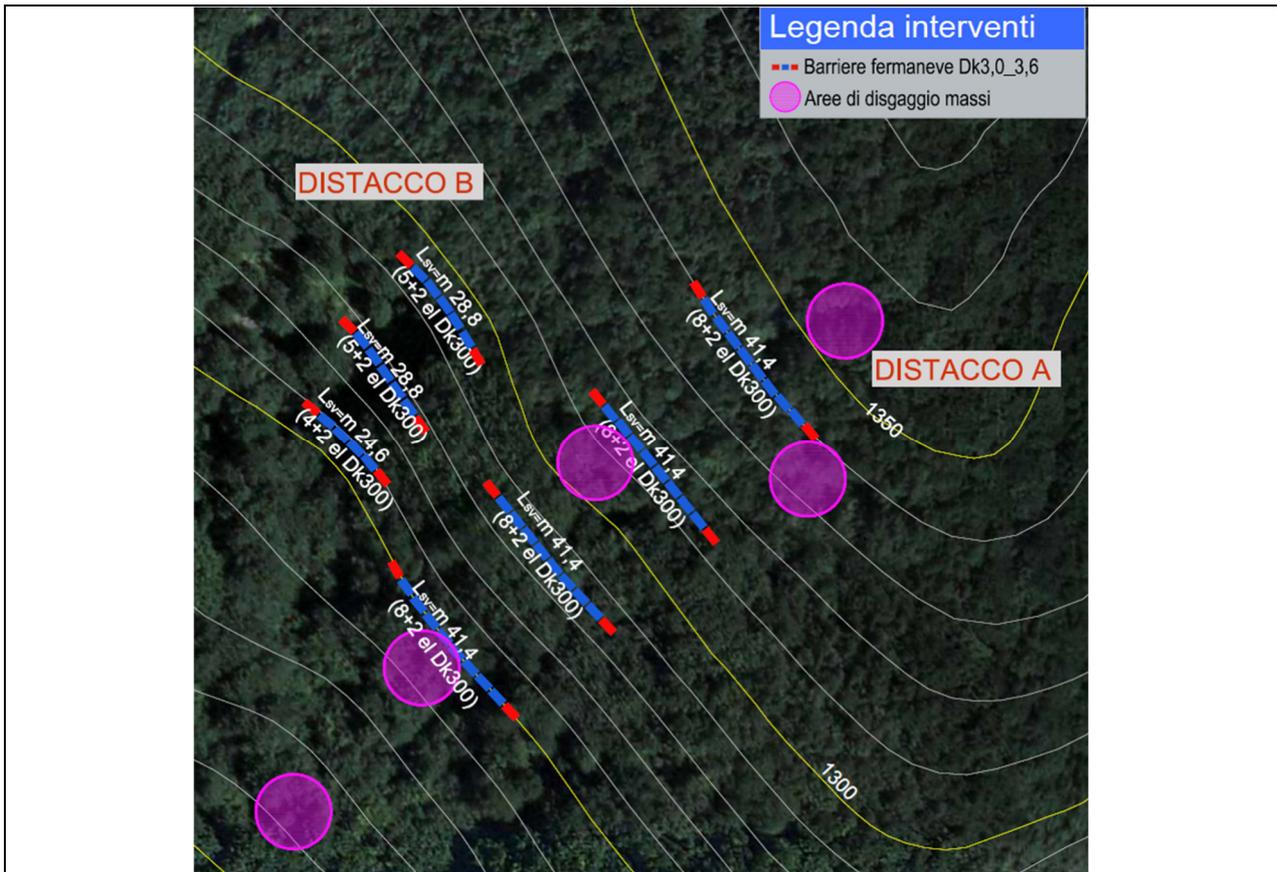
Planimetria barriere fermaneve in progetto (Elaborato B12)
